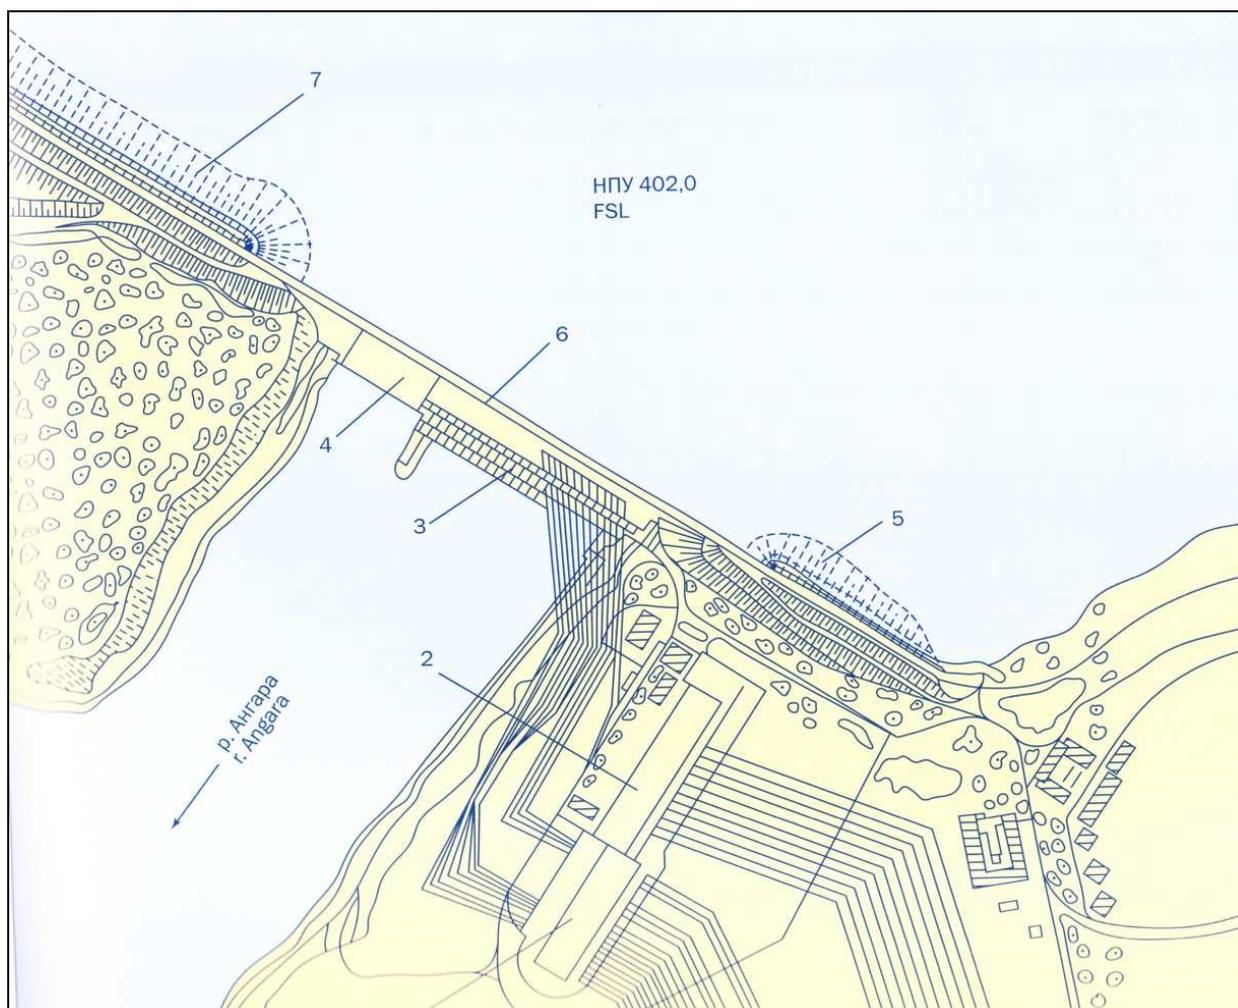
План Братского гидроузла на р. Ангаре с бетонной плотиной и приплотинным зданием гидроэлектростанции:
